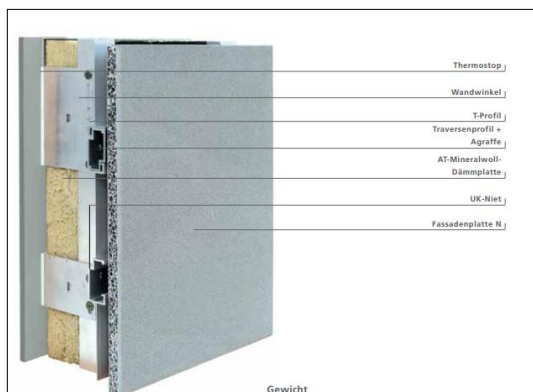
Detall de façana ventilada amb revestiment de pedra.
